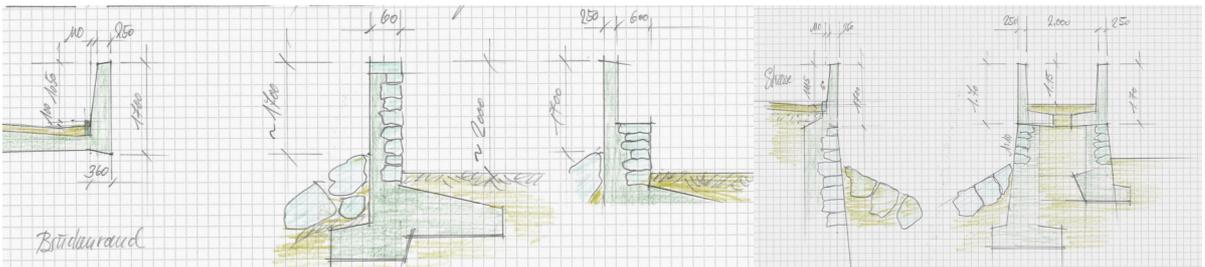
Schizzi di principio dei parapetti uniformi in calcestruzzo dei ponti, del muro di protezione dalle inondazioni Spino e come conclusione sommaria dei muri in pietra naturale
